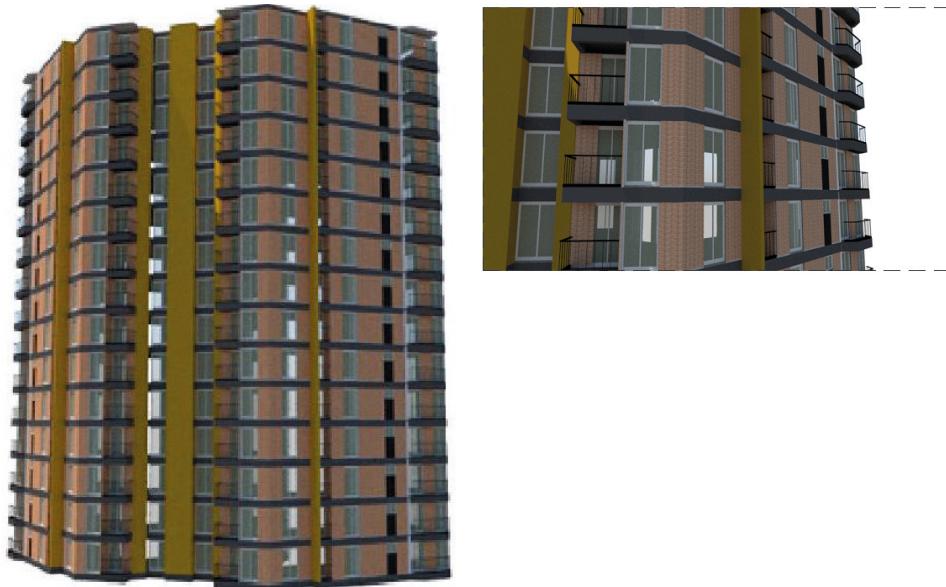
Projeto em 3D da composição da fachada. Acervo do Autor
